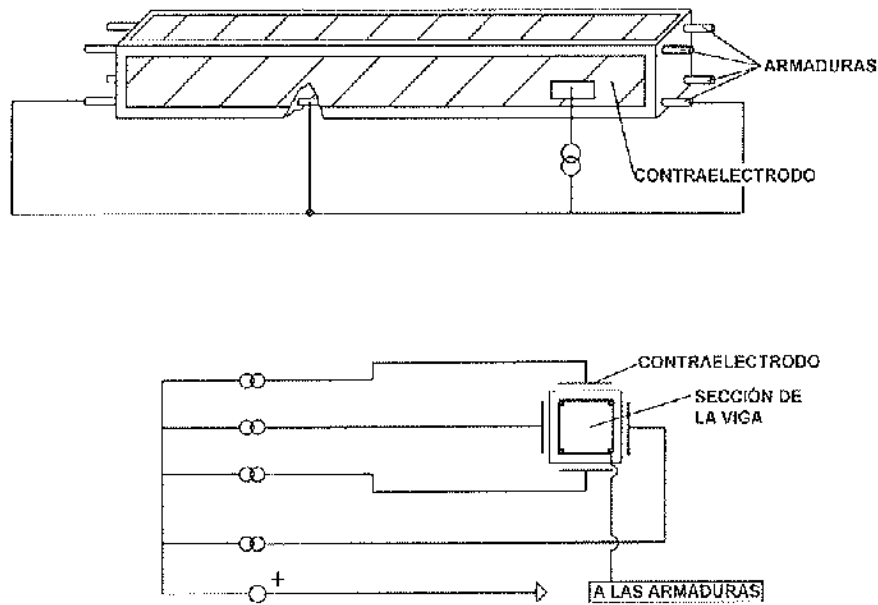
Esquema del dispositivo para la corrosión acelerada de las armaduras en las vigas de hormigón.
